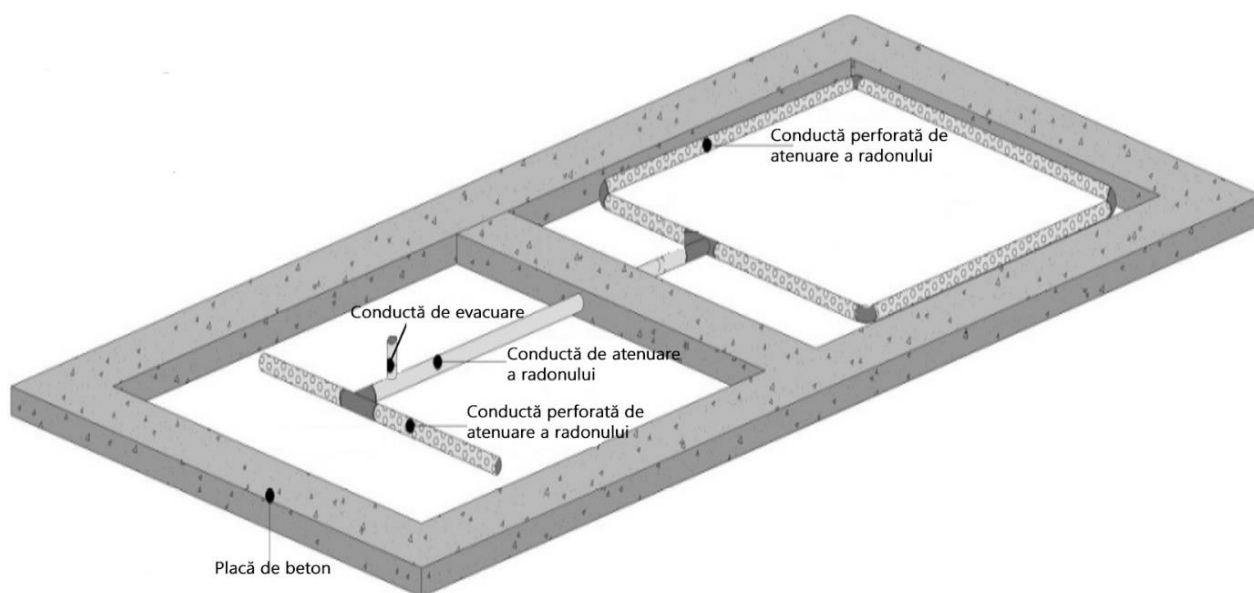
Posibilă legătură a două sisteme colectoare - schema de principiu
